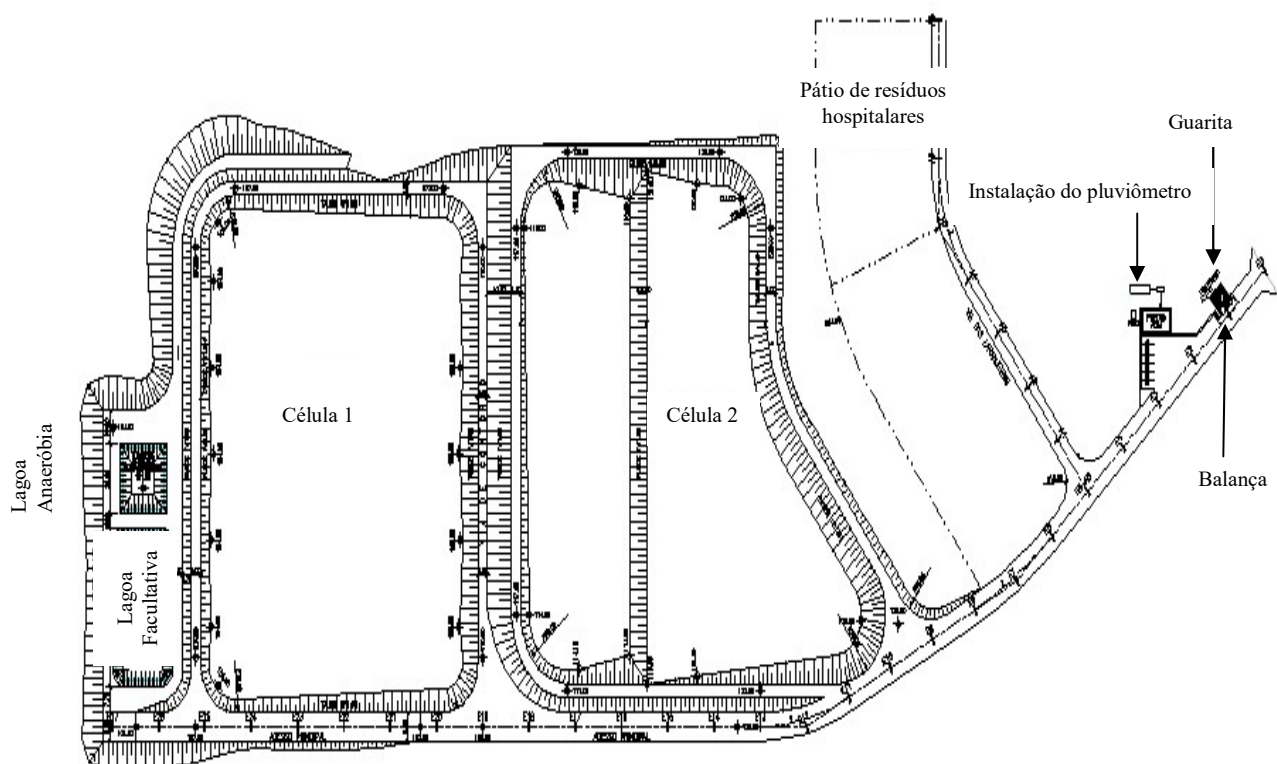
Planta baixa do Aterro Sanitário Integrado de Cruz das Almas/BA
